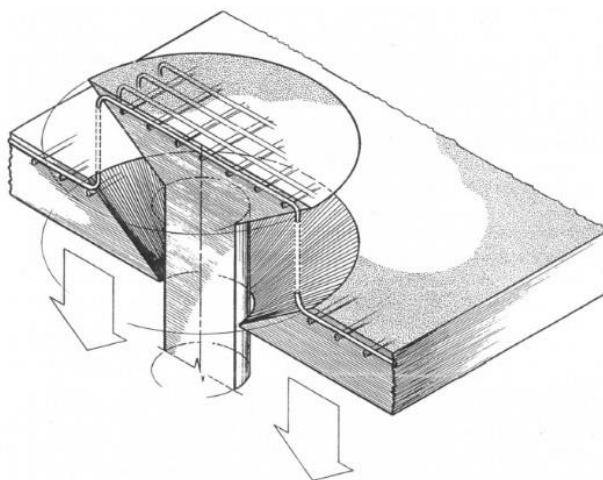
Esquema de rotura ao punçoamento numa laje de betão armado (Menétrey, 1994).
